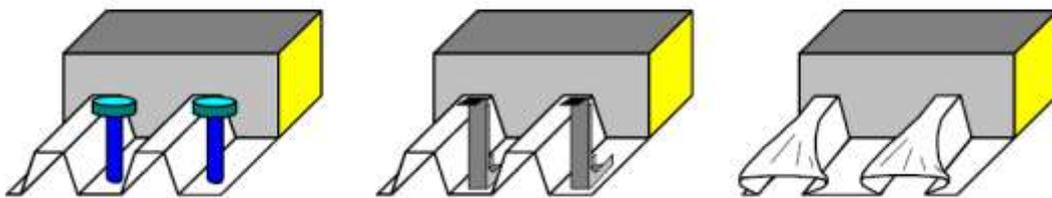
Ancrage d'extrémité dans les dalles mixtes
